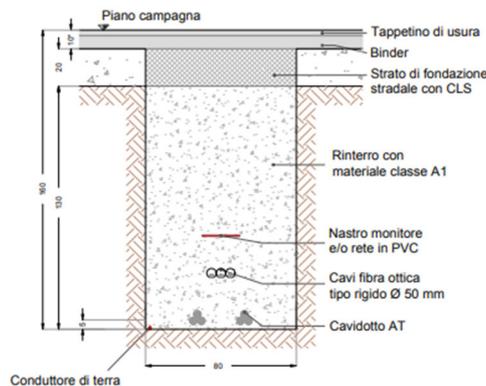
Sezione tipo di posa del cavidotto AT sotto strada in asfalto (misure in cm)
